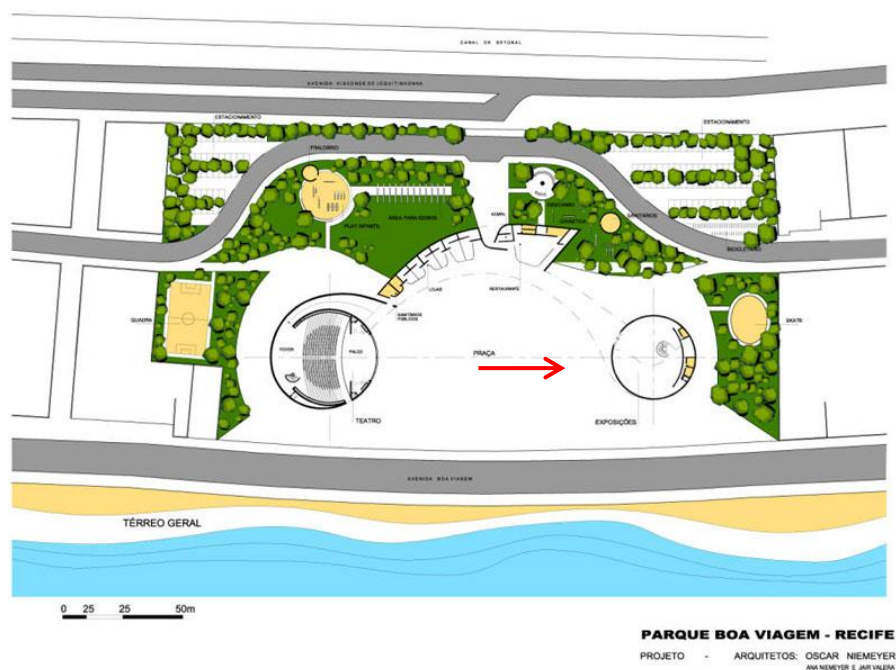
Planta Baixa do Parque Dona Lindu, com Galeria indicada.
